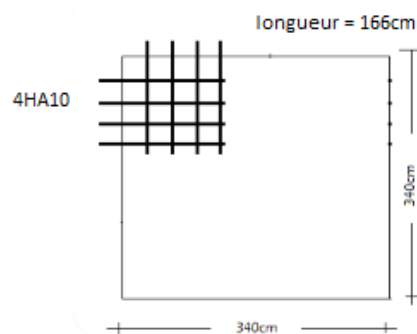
Schéma du ferrailage en appui des dalles. (Nappes supérieures).
